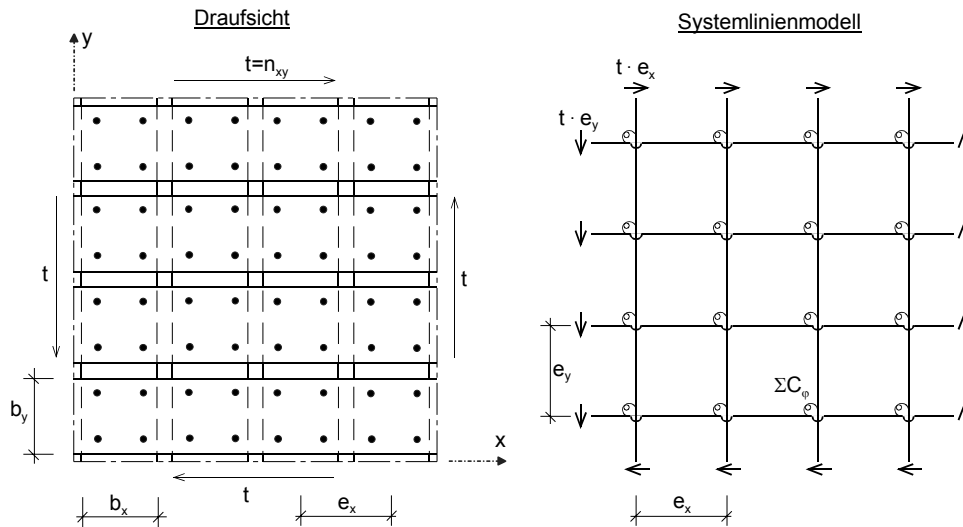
Ausschnitt aus einem genagelten Brettsperrholzelement.
